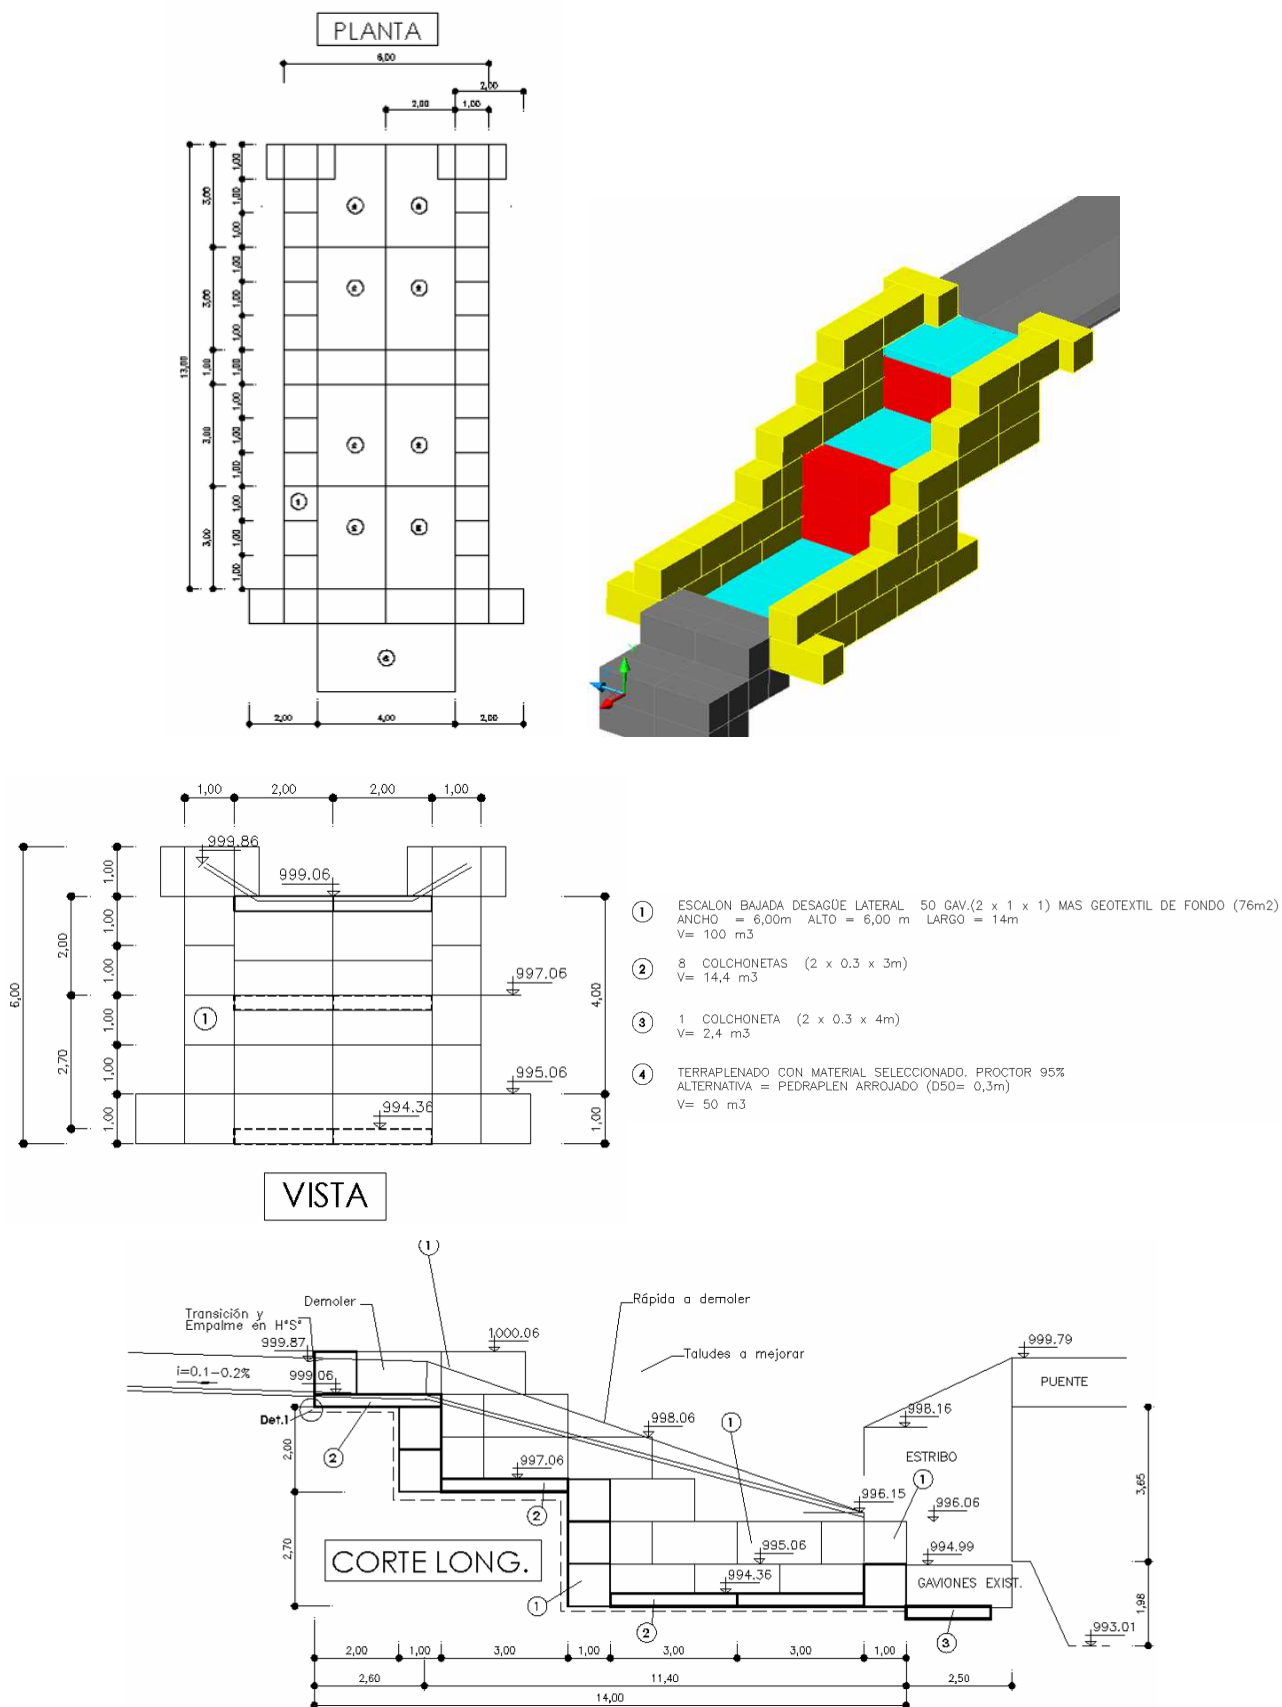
Detalle de Escalera de gaviones para control erosión estribo izquierdo puente A° Salamanca.
